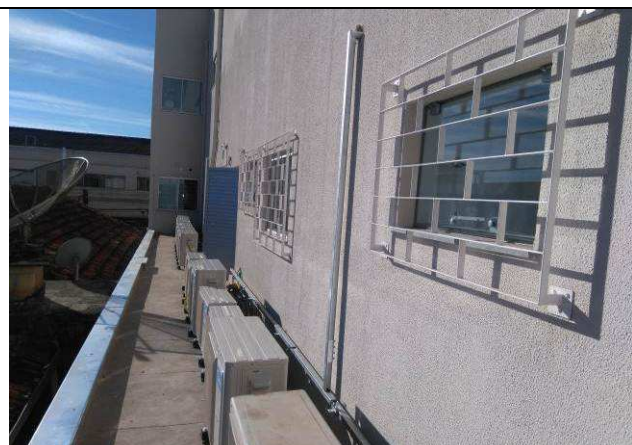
E: Infraestrutura perfilados - alimentação condensadoras 1º pavimento.
